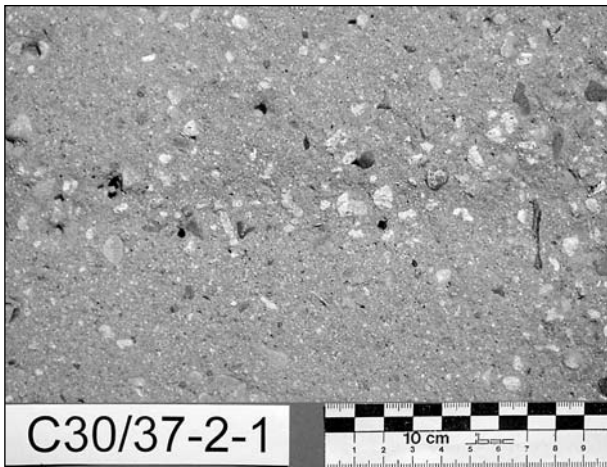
Beton C30/37 nach Kugelstrahlen, mittlere Rautiefe
